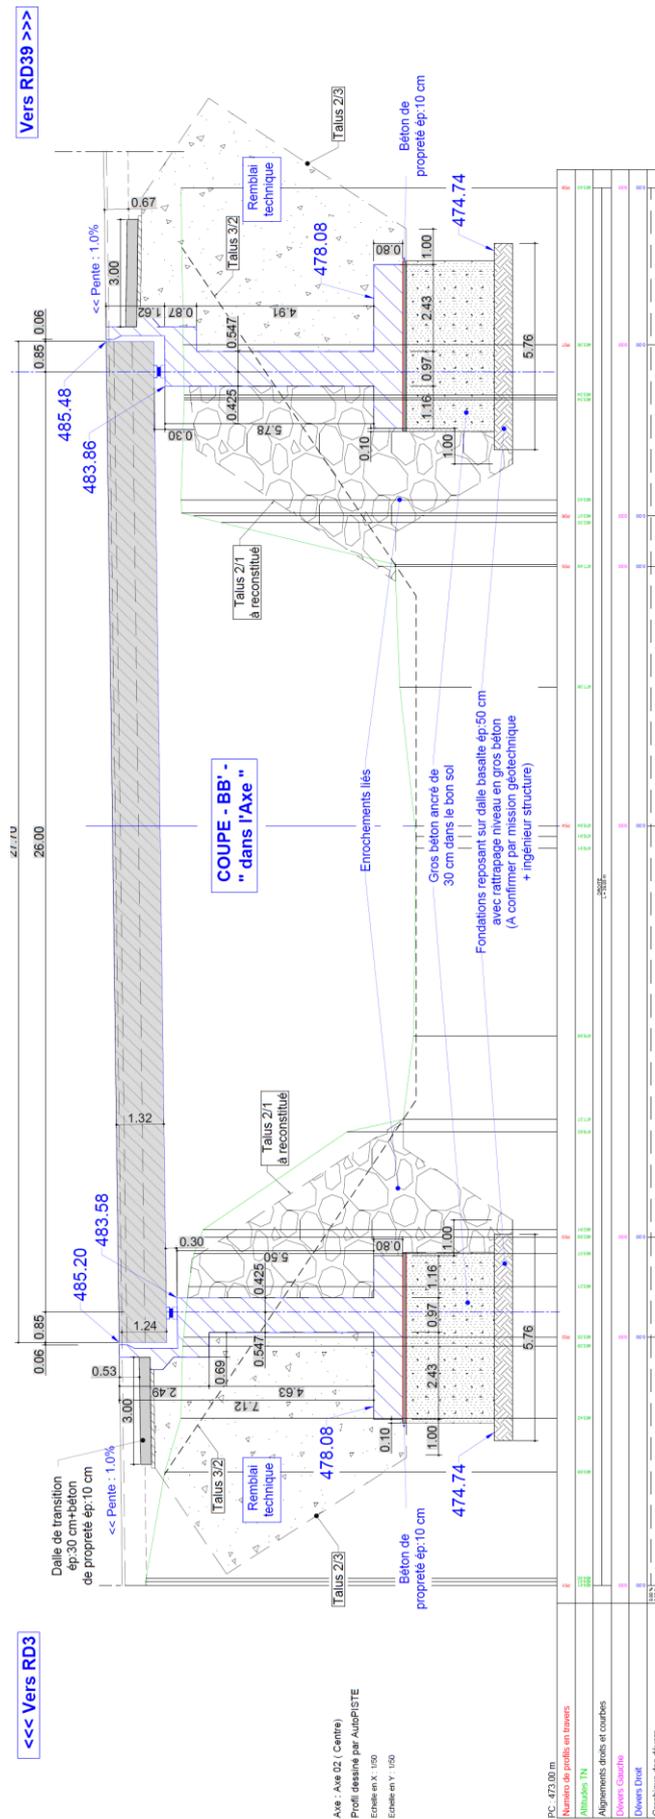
Coupe de l'ouvrage de franchissement de la Ravine Blanche
